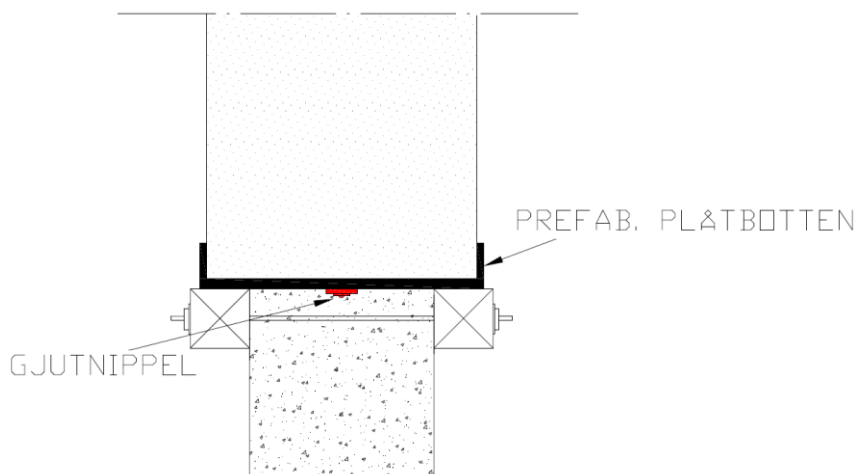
Profil från långsida av ok i dimension 45x125 millimeter.
